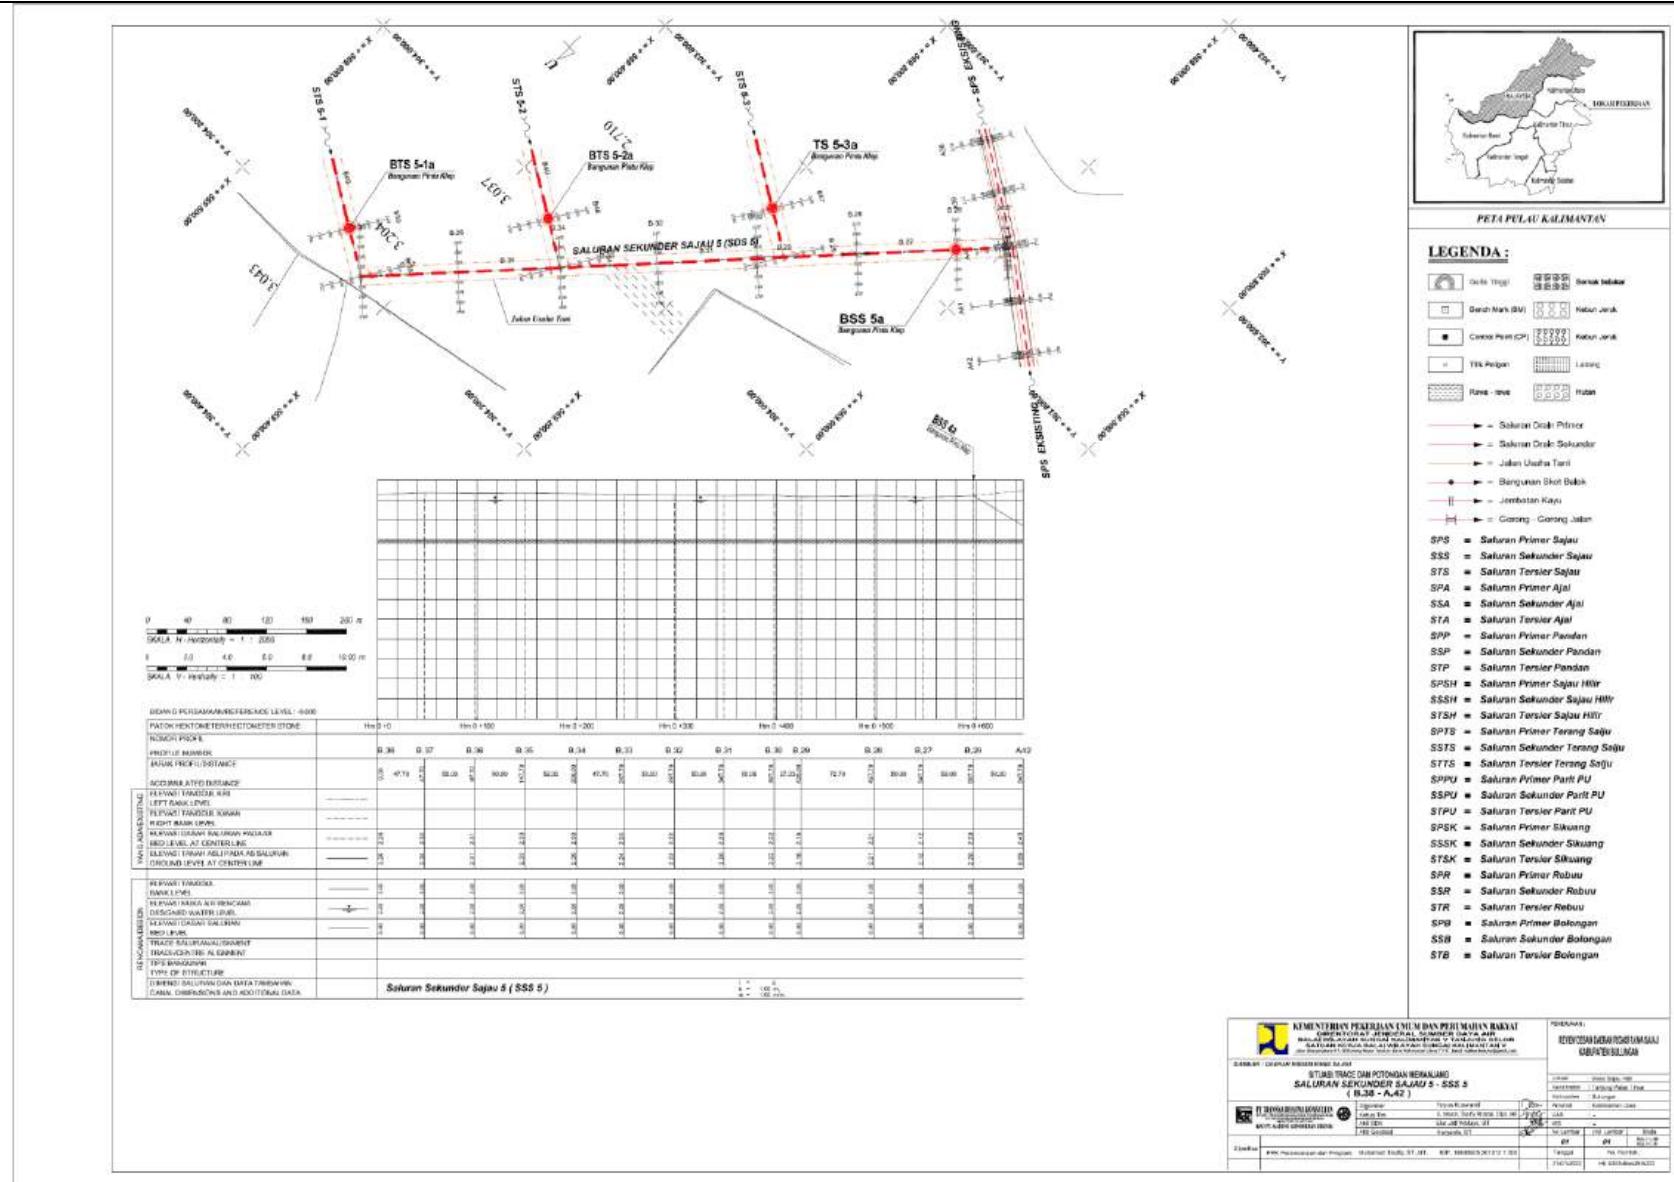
Contoh Profil Memanjang Pada Saluran Eksisting pada Blok Sajau
